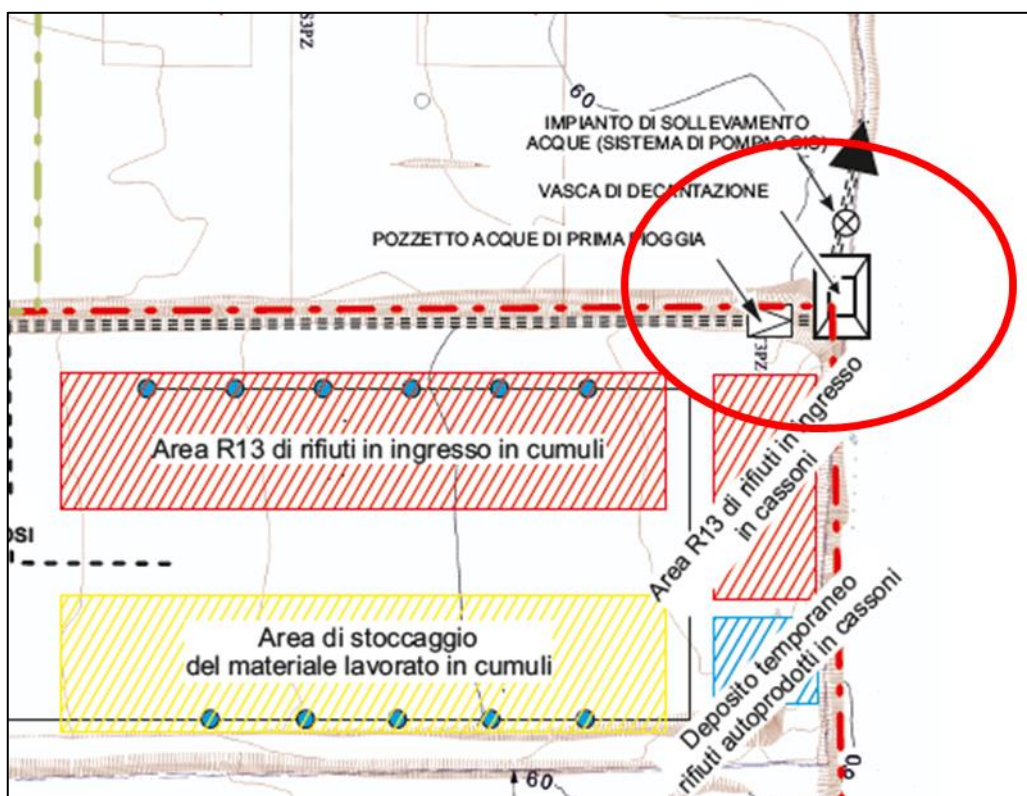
Stralcio della planimetria di progetto con evidenza del sistema di gestione delle acque meteoriche
